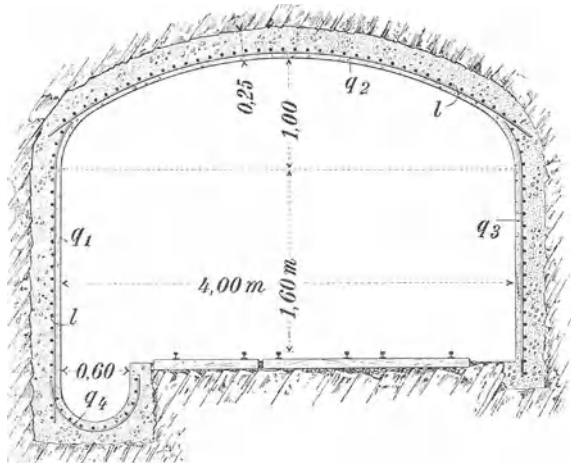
Eisenbetonausbau eines Hauptquerschlags.
